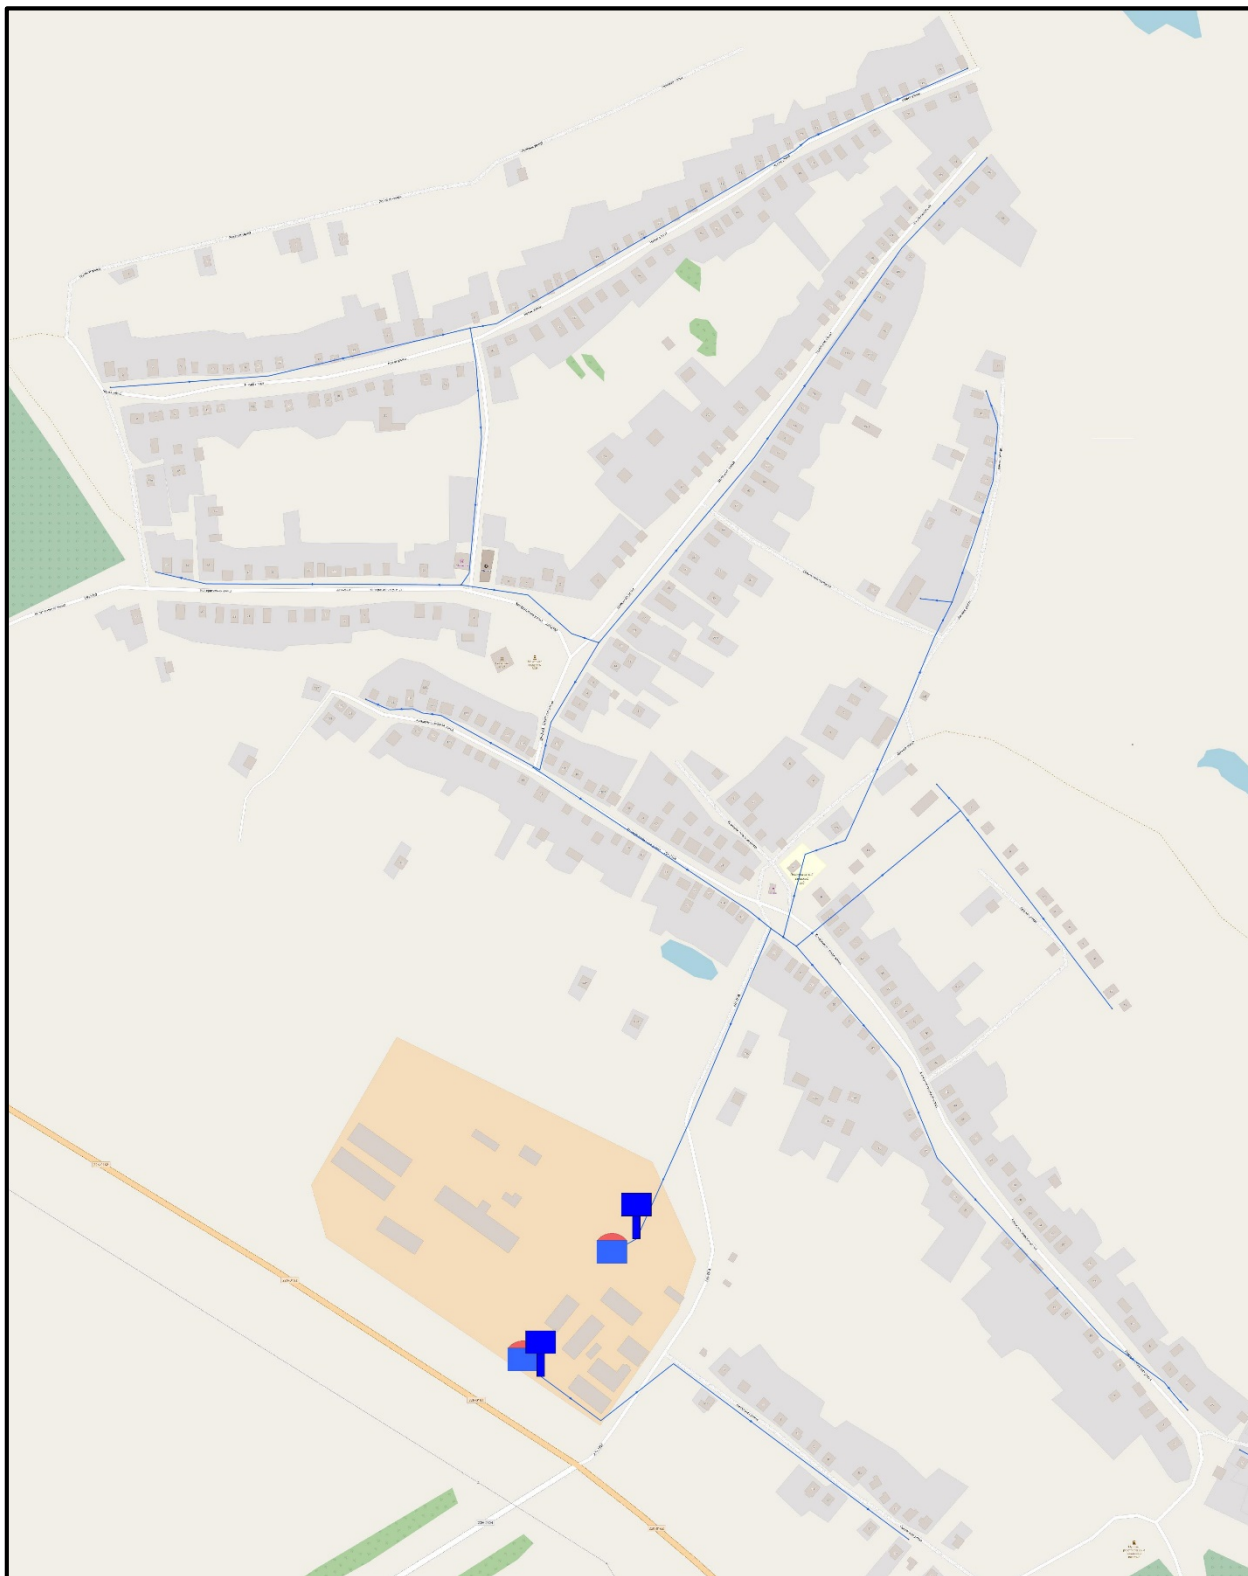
Схема водоснабжения д. Пошатово
